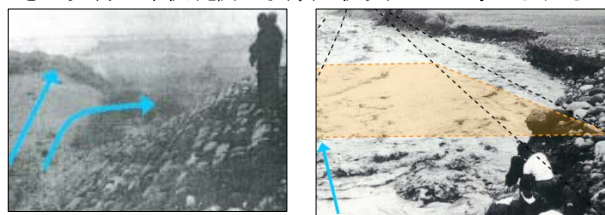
岩峠野堤護岸の破堤状況 (S44. 8. 11)
